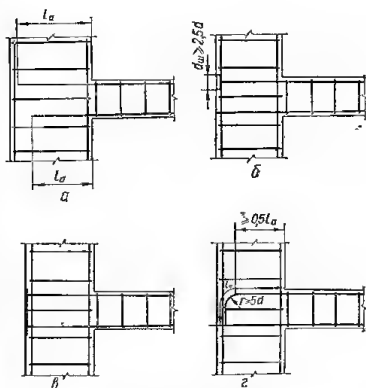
Анкеровка ненапрягаемой арматуры на защемленных опорах:
